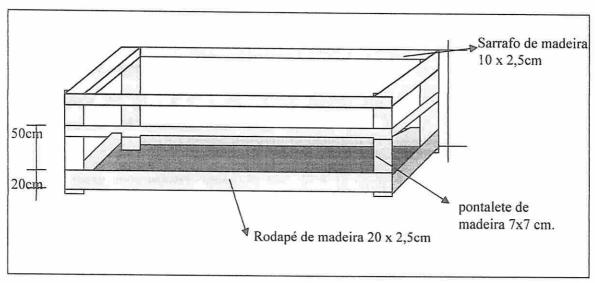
Proteção das aberturas das lajes e poços de ventilação:
